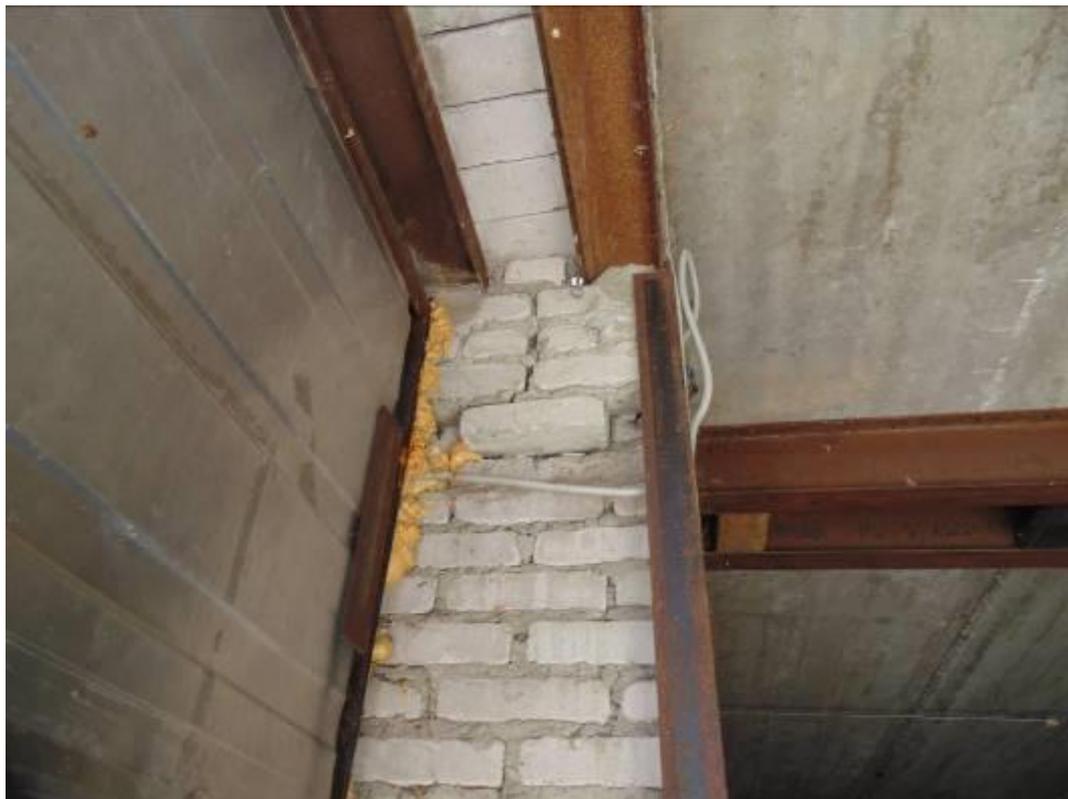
Разрушение и растрескивание кирпичной кладки стен.
